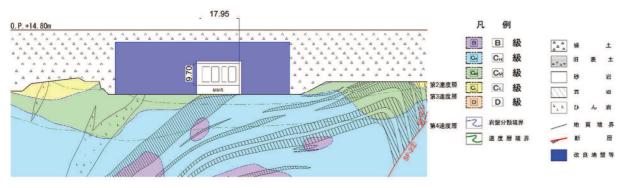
地盤改良体の配置図(原子炉機器冷却海水配管ダクト, E-E 断面)
